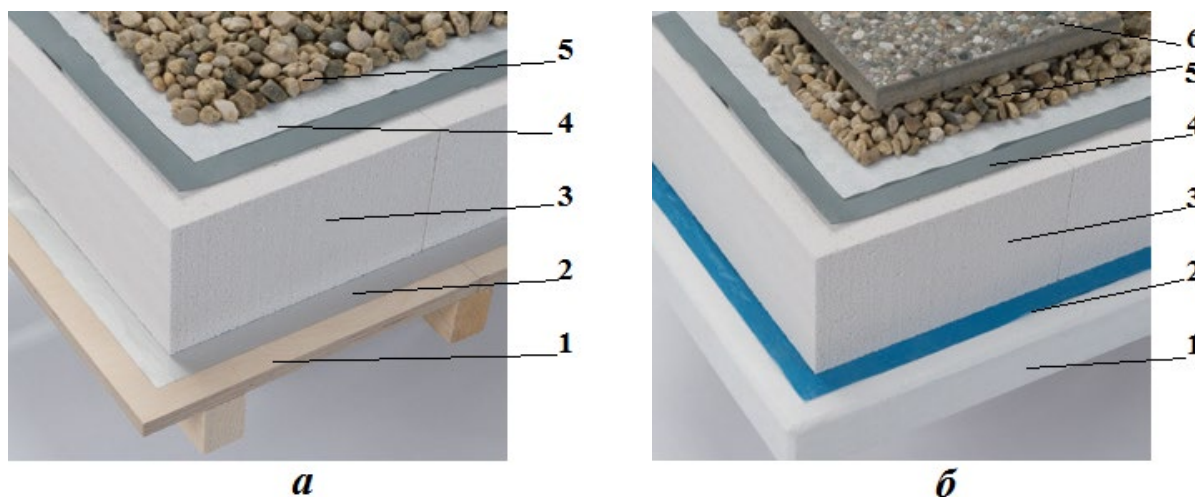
Плоская балластная кровля: а – по деревянному основанию; б – по основанию из газобетона: 1 – основание; 2 – пароизоляция (а – многослойная алюминиевая фольга; б – полиэтиленовая пленка); 3 – минеральная изоляционная плита; 4 – полимерная кровельная мембрана; 5 – балласт (гравийное покрытие); 6 – тротуарная плитка
